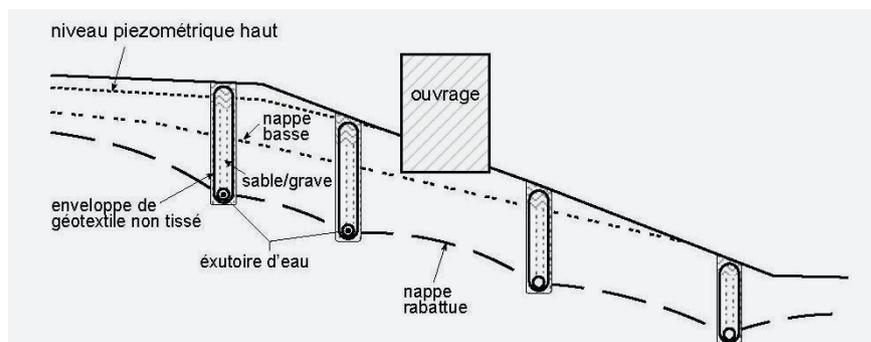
ouvrage sur pente à stabilité précaire en nappe haute ; stabilisation par tranchées drainantes.
